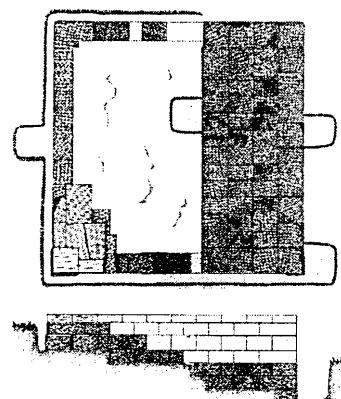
ライオントマスの遺構(上: 平面図、下: 東立面図)
